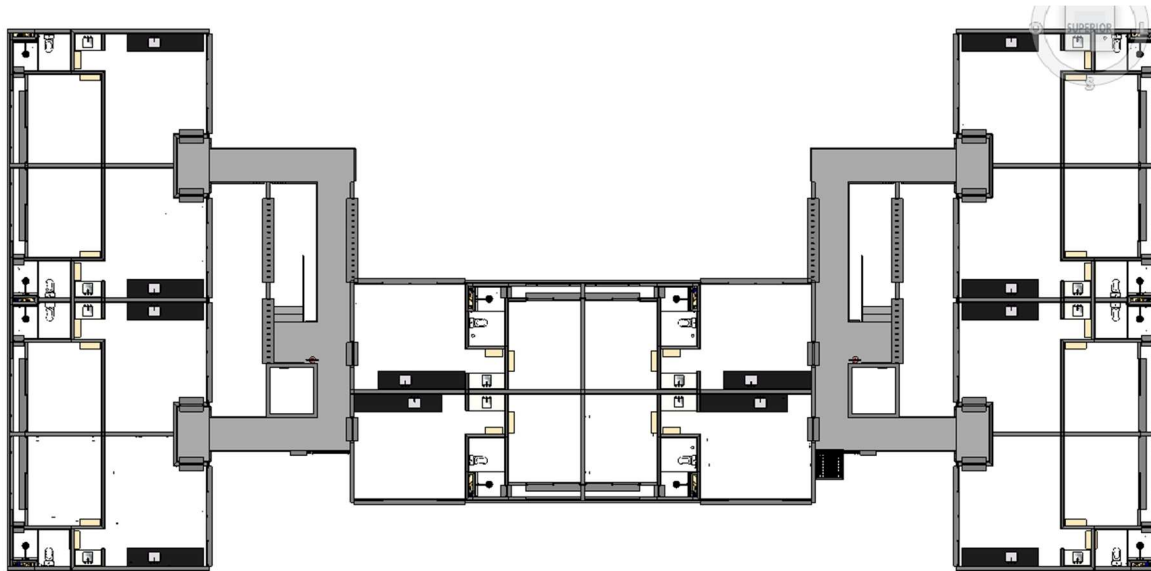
Planta baixa do 1º pavimento com layout de distribuição interna.
